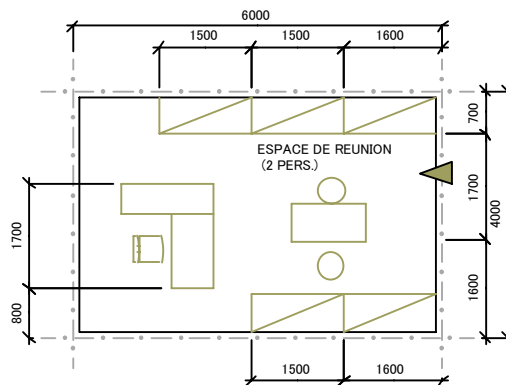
Plan planimétrique du bureau de maintenance des installations
